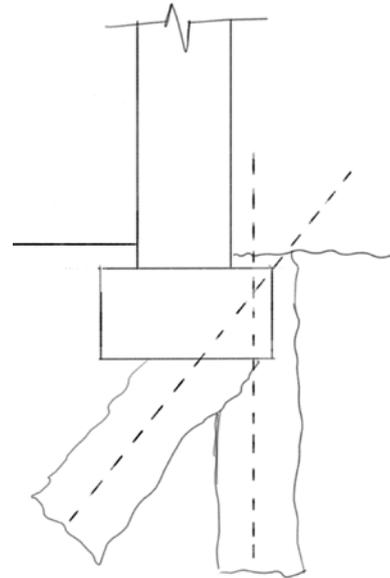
Estabilización de zapata de cimentación, inyectando lechada de CAA mediante *jet-grouting
